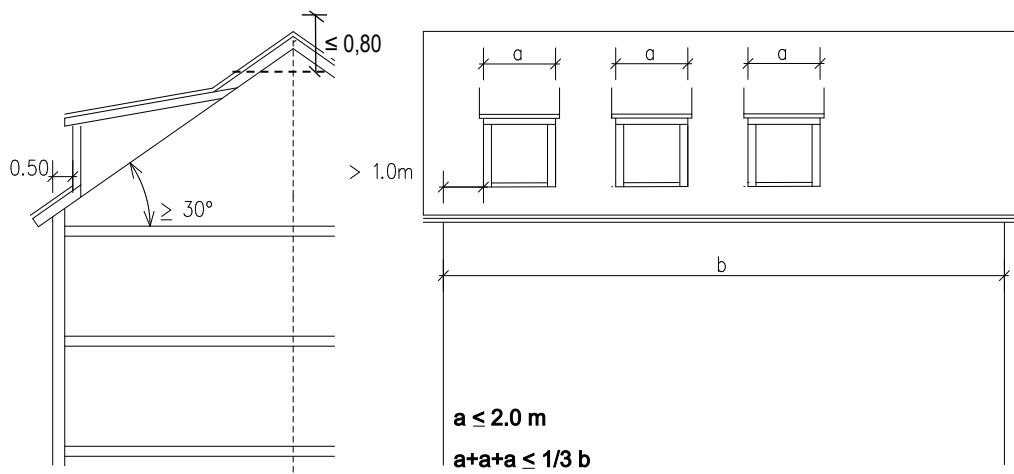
Anordnung und Abmessung von Dachaufbauten
